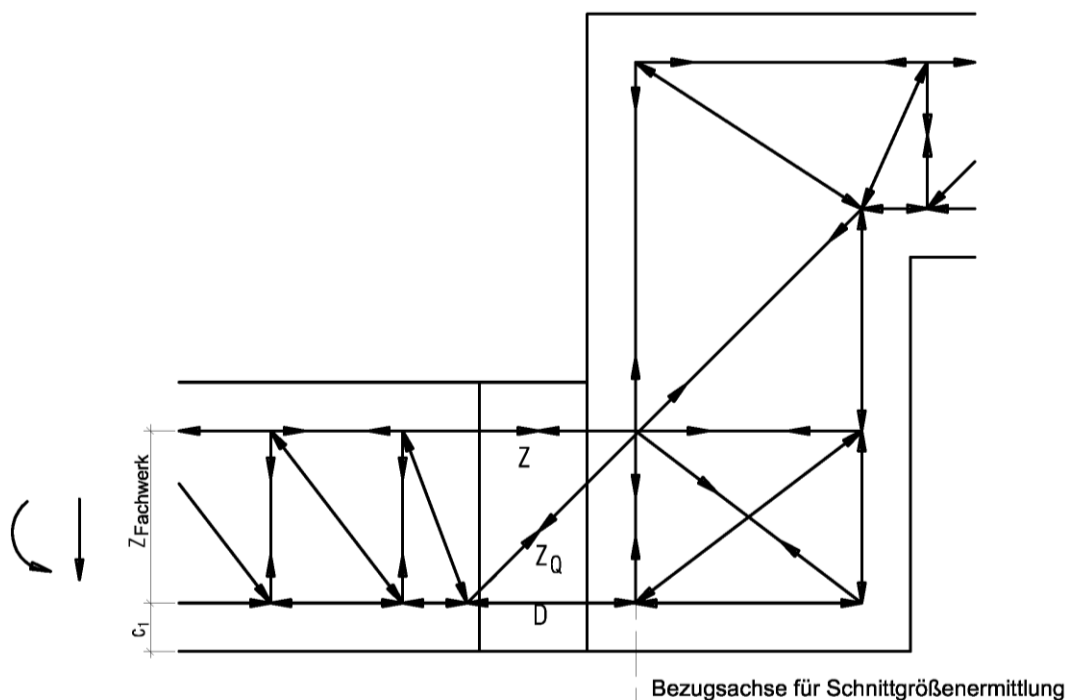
Schöck Isokorb® Typ K mit Betondrucklager (Variante Höhenversatz)
